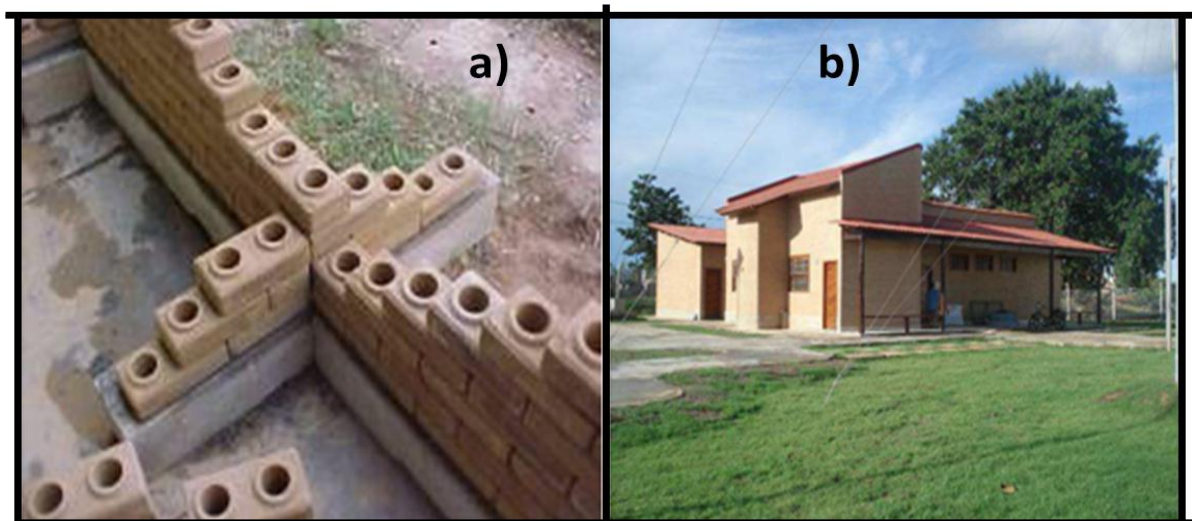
3. – (a) Tijolos de solo-cimento e (b) Construção civil em solo-cimento (Lima, 2006; Destefani, 2009).
